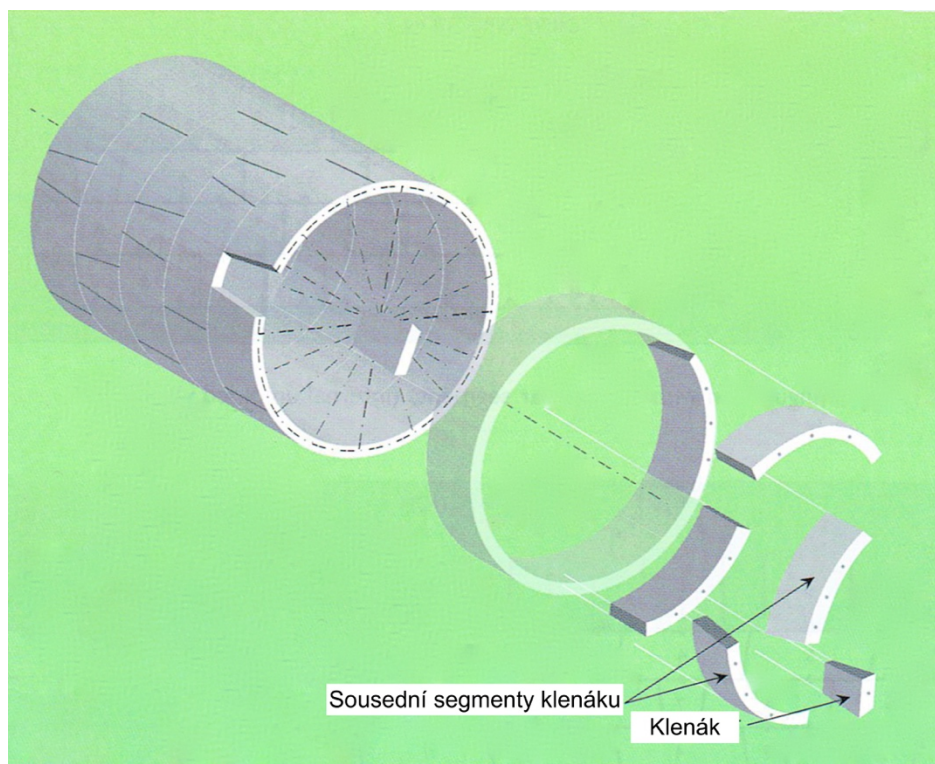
konstrukční schéma tunelu z obdélníkových segmentů 5+1 [5]
